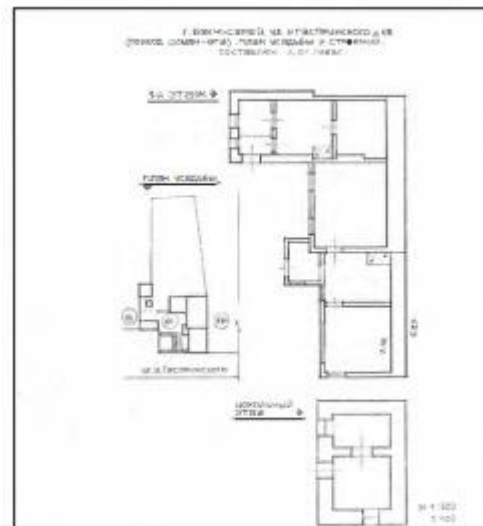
План садиби і будов будинку з виступаючими дерев'яними консолями (вул. І. Гаспринського, 8) / Fig. 6. House plan and buildings with protruding wooden consoles (I. Gasprinsky St., 8)
